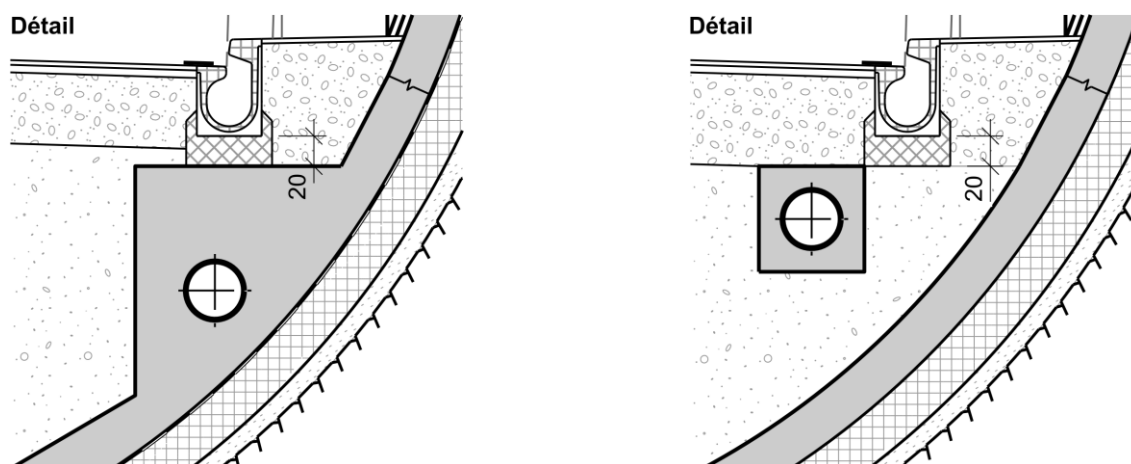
Fondation du caniveau fendu sur couche de fondation (gauche)/ sur socle en béton (droite)
